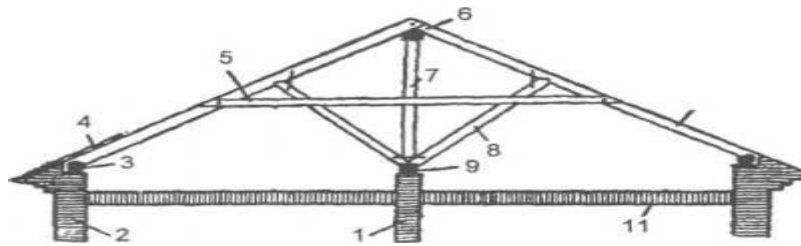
Дерев'яна конструкція з похилими стропилами:
